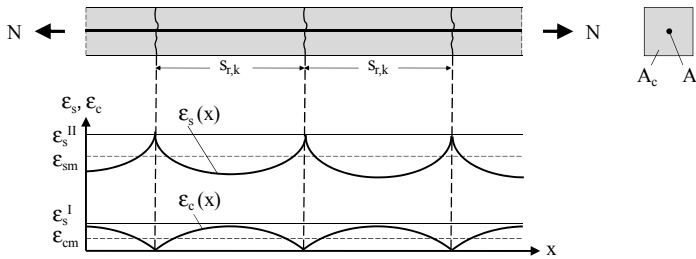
Charakteristischer Rissabstand im Stahlbetonzugstab
